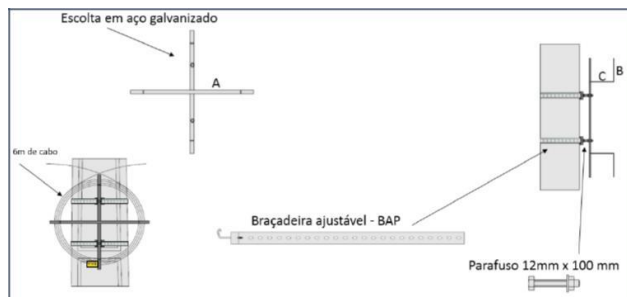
Reserva Técnica em Escolta (Cruzeta)
